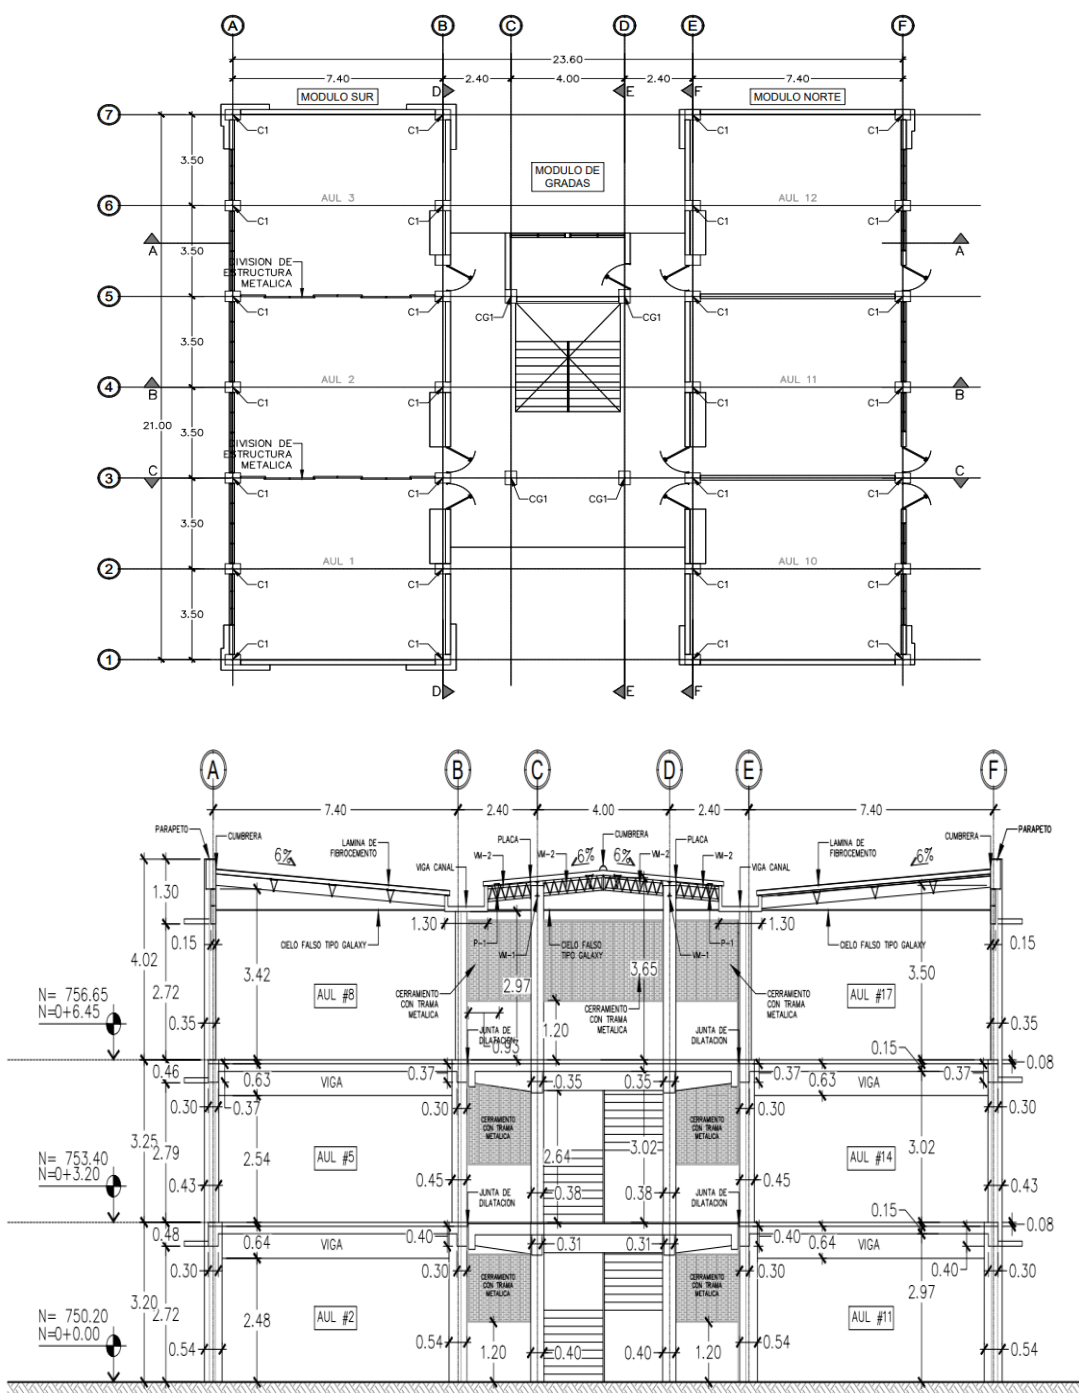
Esquema en planta y elevación de la edificación en estudio
